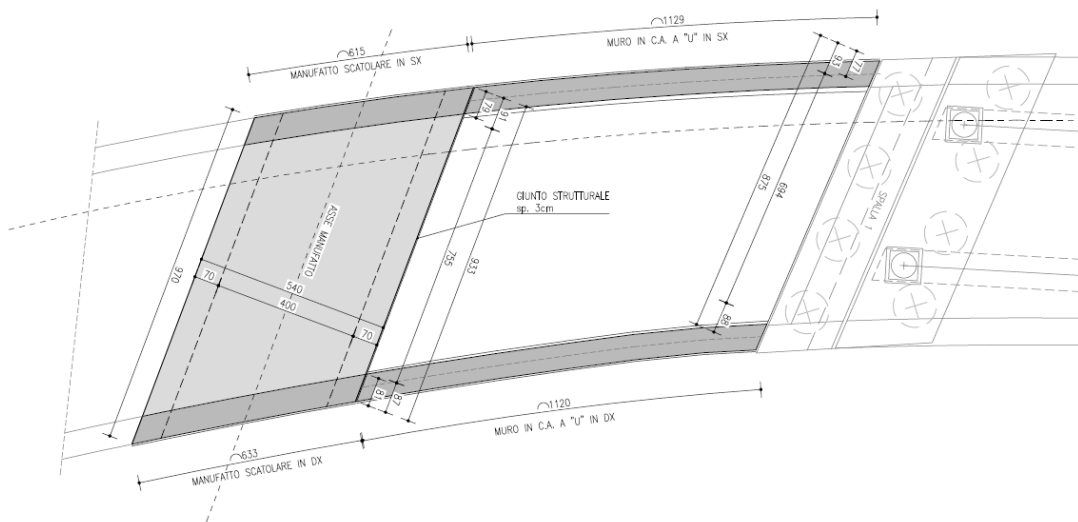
Scatolare e muro a U lato sud – carpenteria fondazioni
